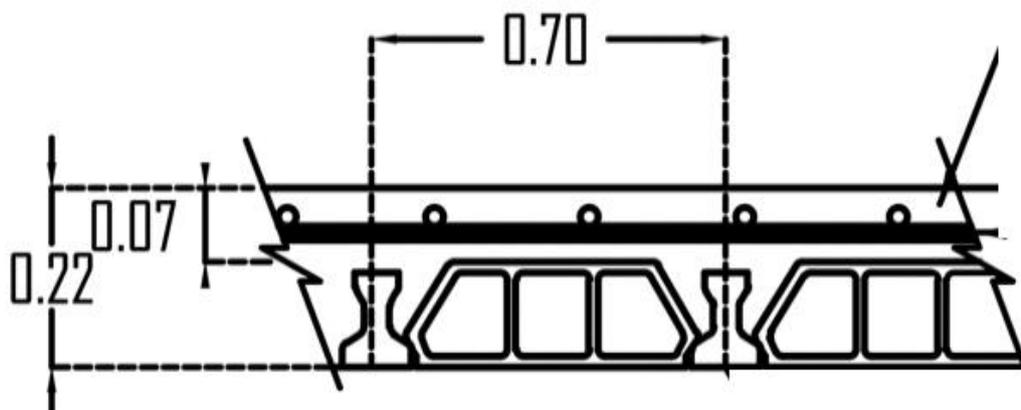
Продольный разрез сборно-монолитной плиты с фигурными пустотами
